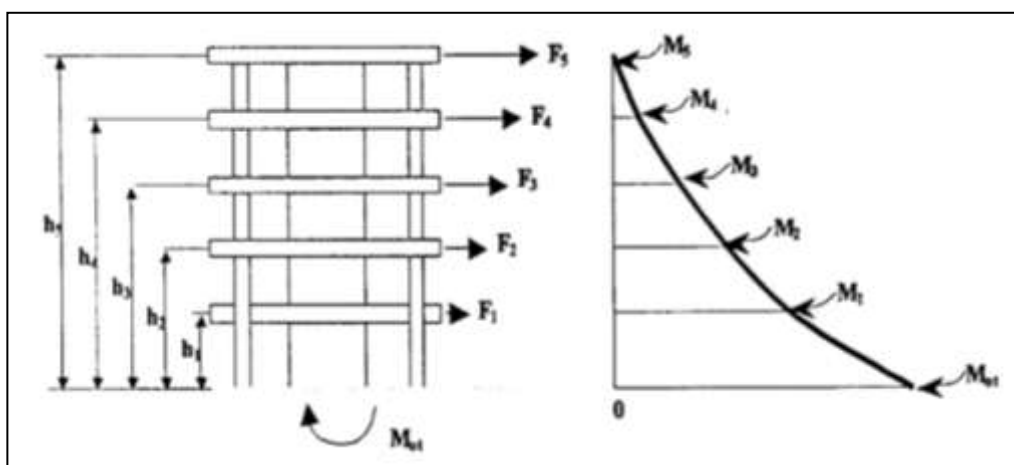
Cálculo del momento de vuelco; Fuente: (AMERICAN CONCRETE INSTITUTE, 2010)
